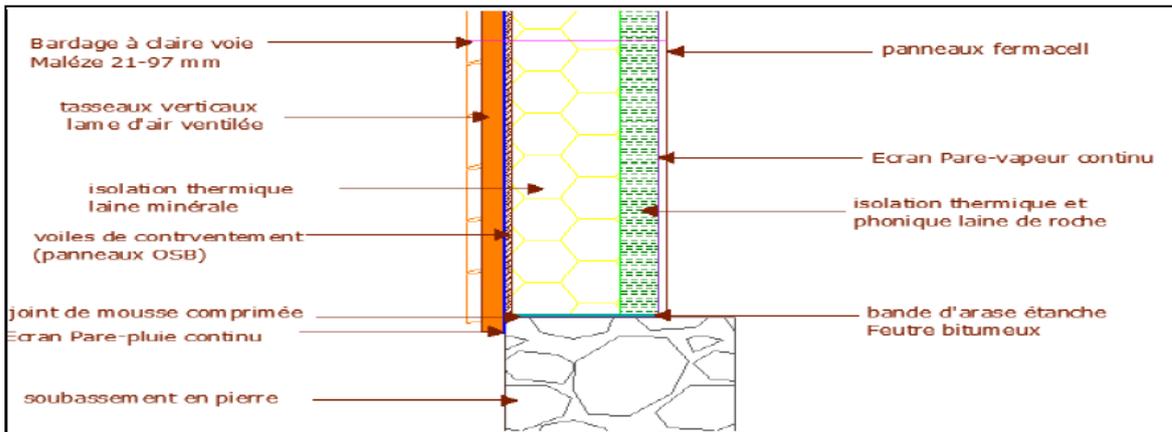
détail d'assemblage mur en bois/soubassement en pierre
